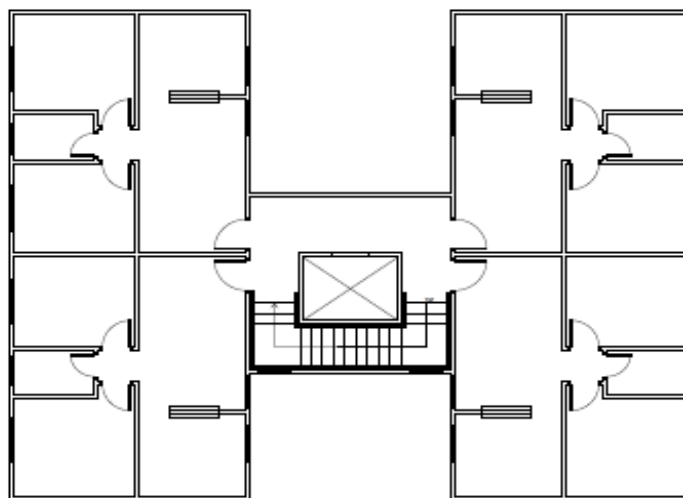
Planta do pavimento tipo em parede de concreto sem escala.
